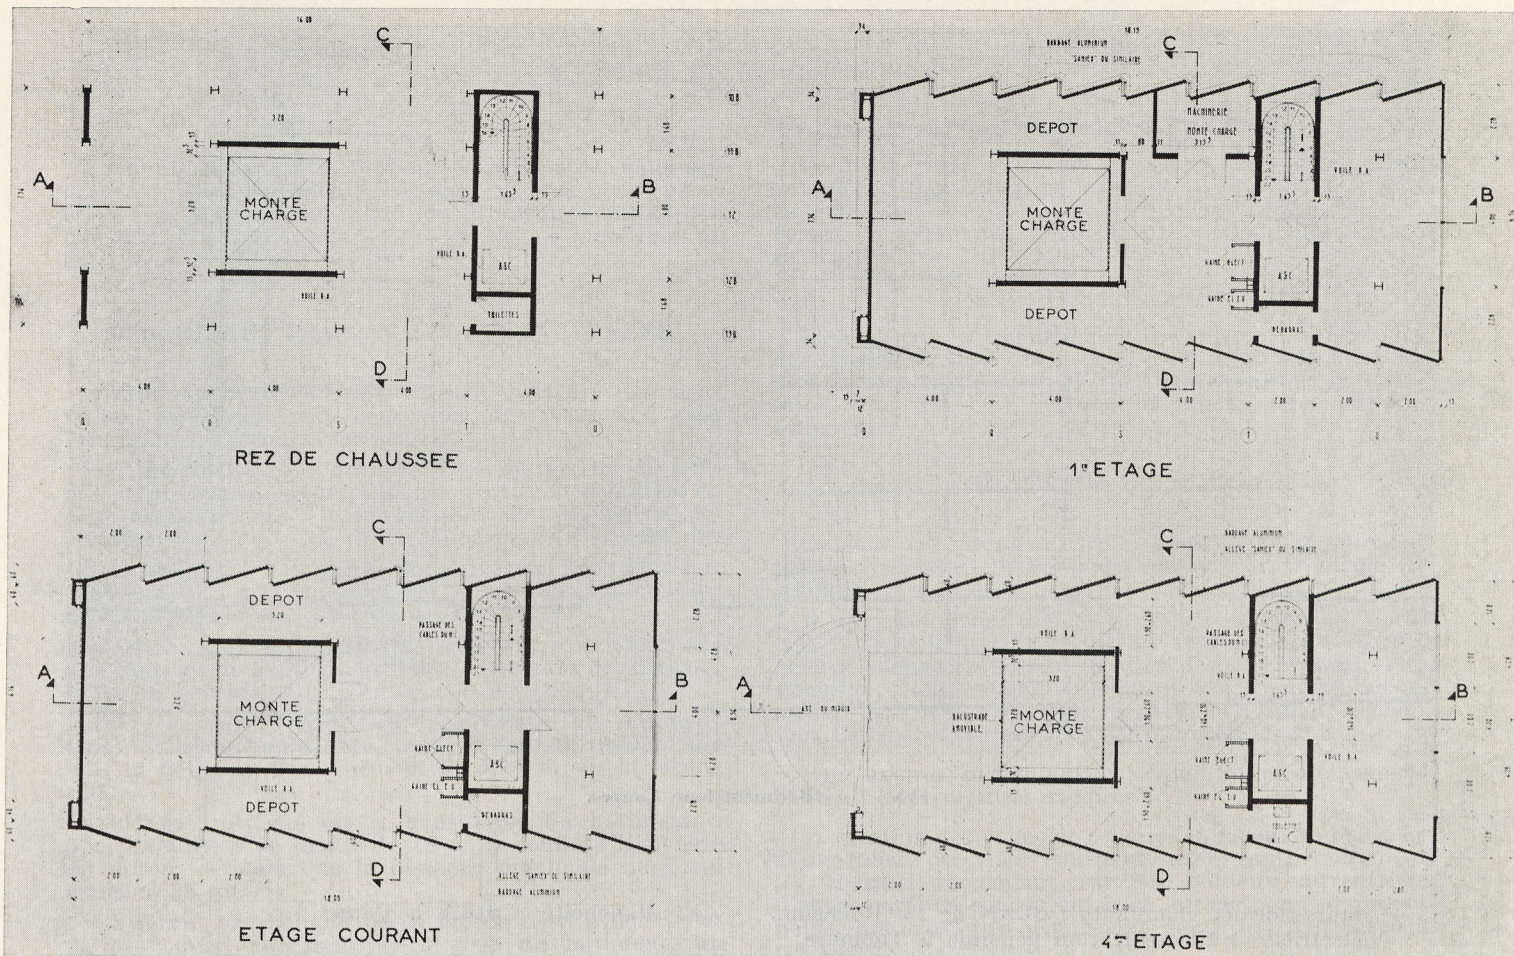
Bâtiment-four. Plans des divers niveaux.
